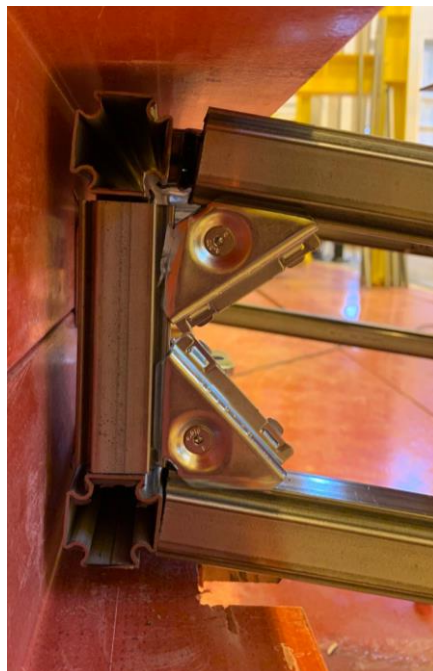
Разкрепление цапок уголковых соединителей с ненагруженной стороны
